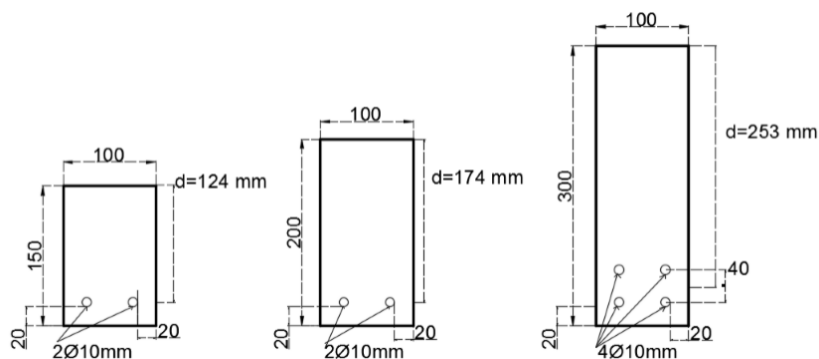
Seções transversais das vigas sem armadura transversal, dimensões em mm (Sathiyamoorthy, 2016).
